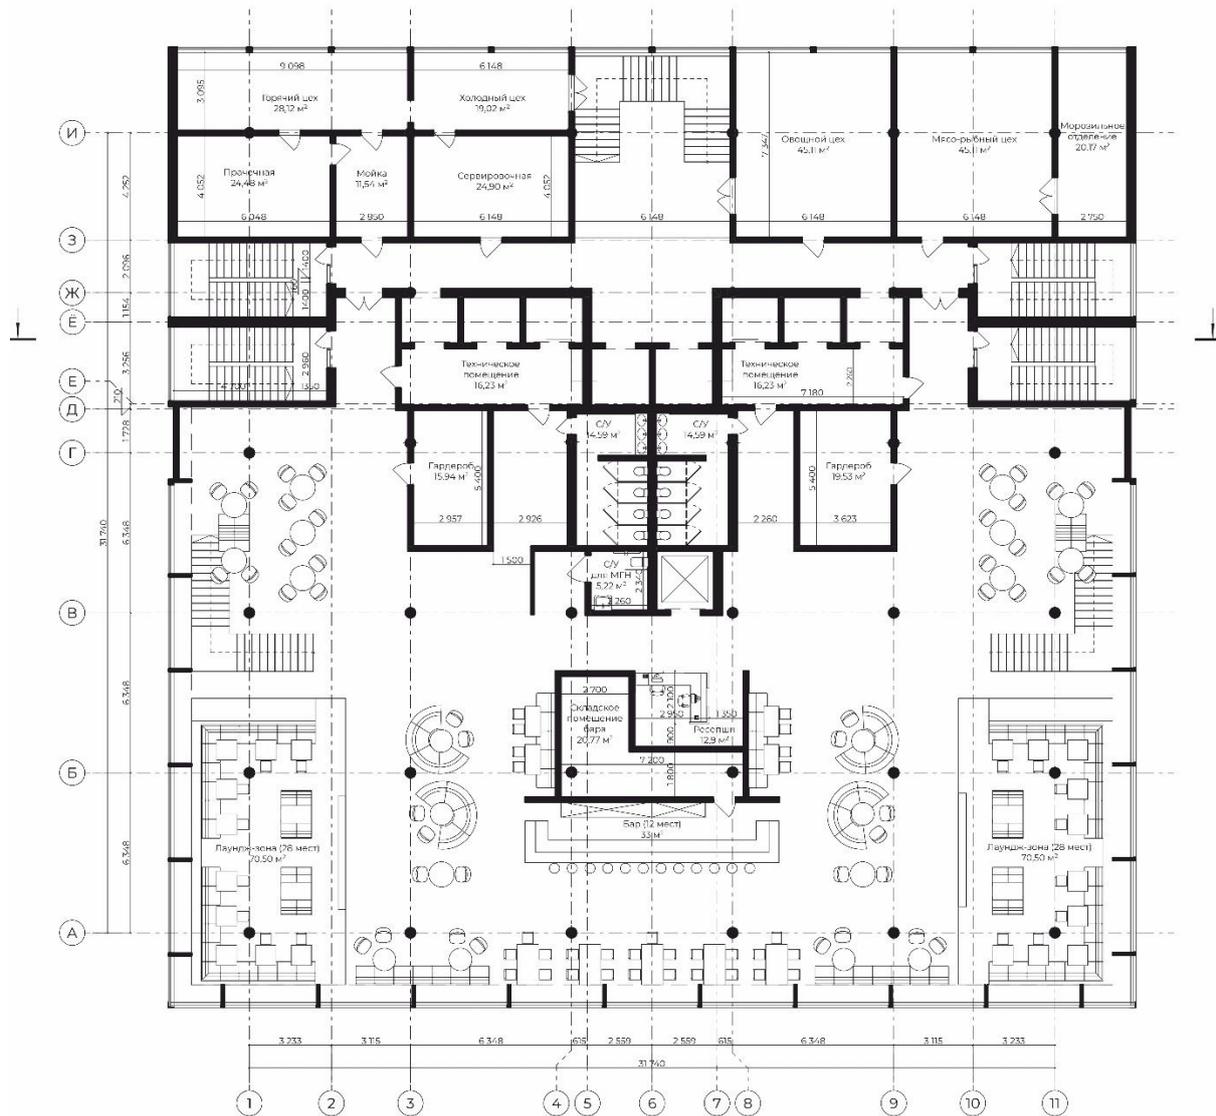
План первого этажа ресторана (28 этаж здания)
